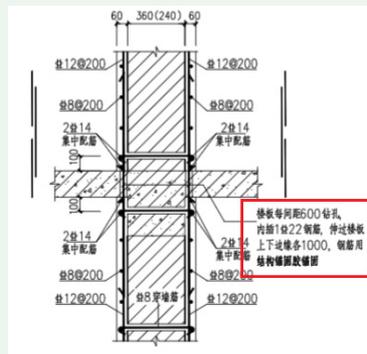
钢筋混凝土面层竖向钢筋在楼面板处连接做法（现浇板）
